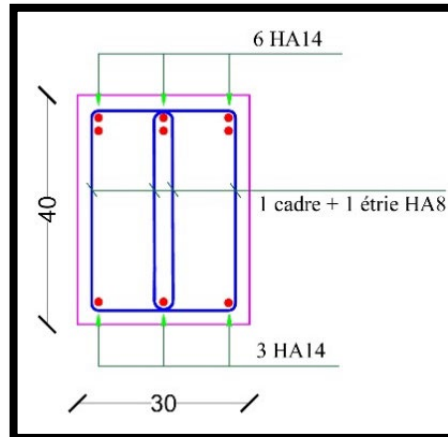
Ferrailage de poutre secondaire en appuis
